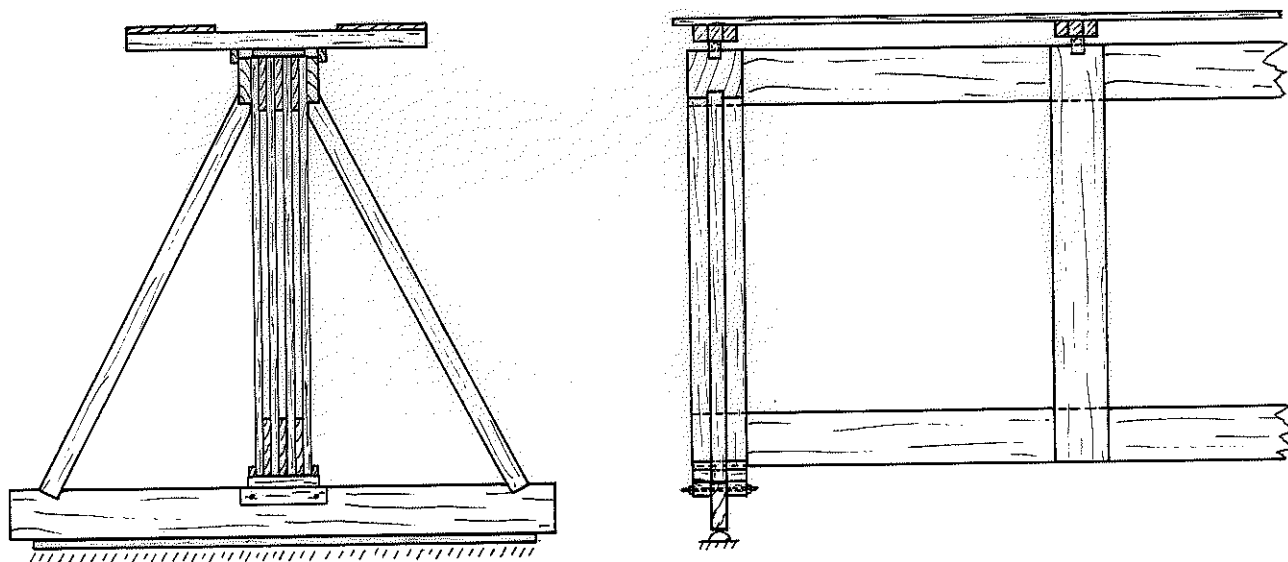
Contraventamento Utilizado na Experimentação da Viga Vierendeel.
